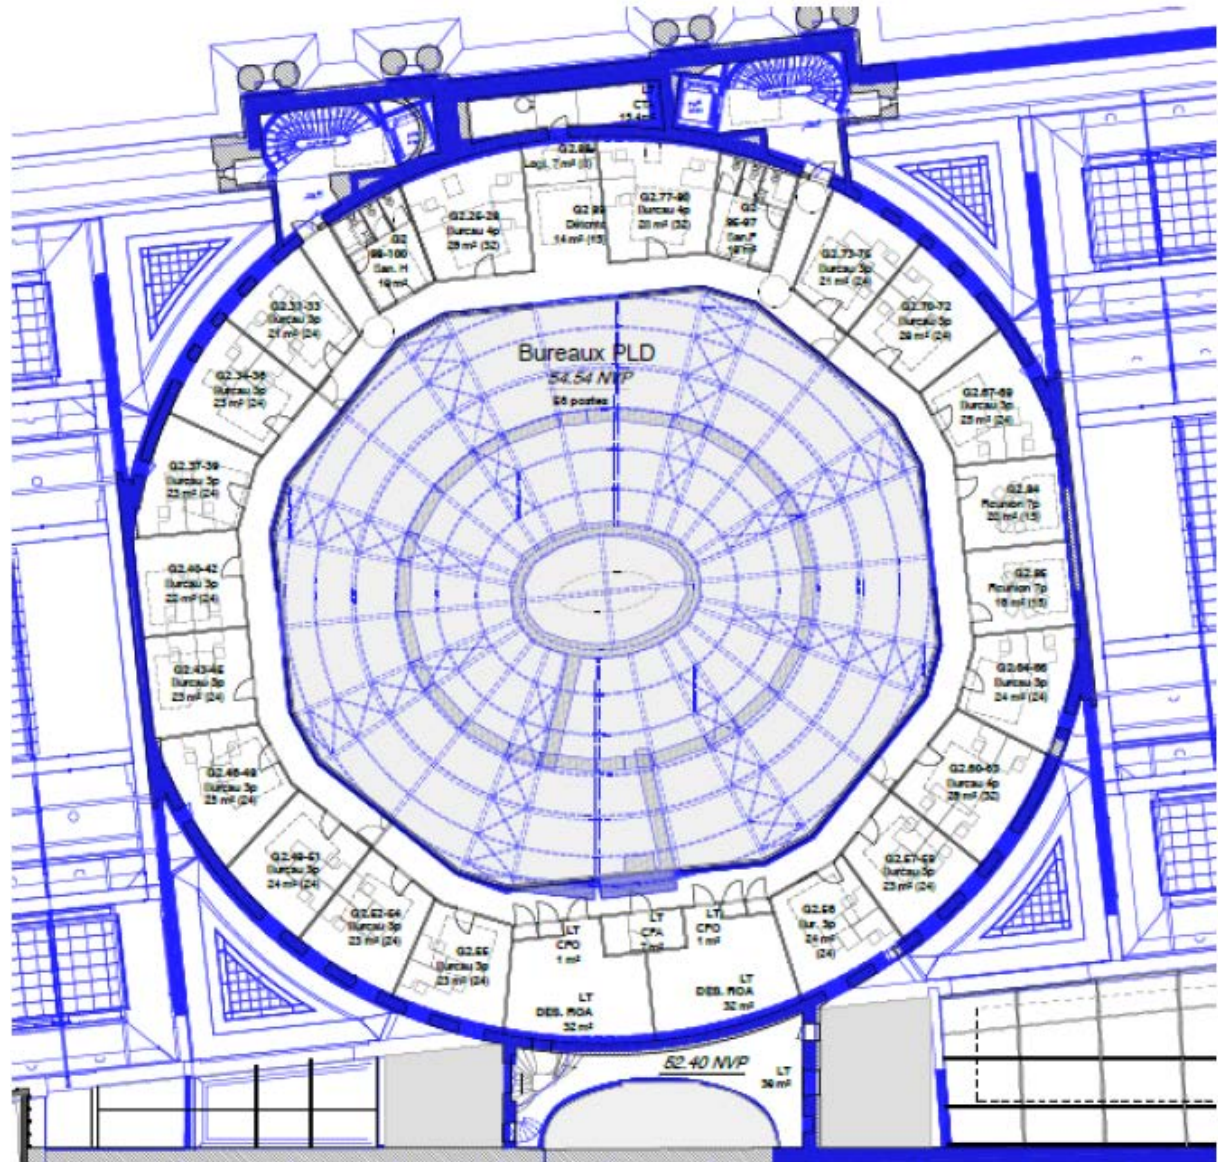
Combles du Palais d'Antin, plan des 56 postes de travail du Palais de la découverte (c) LAN
